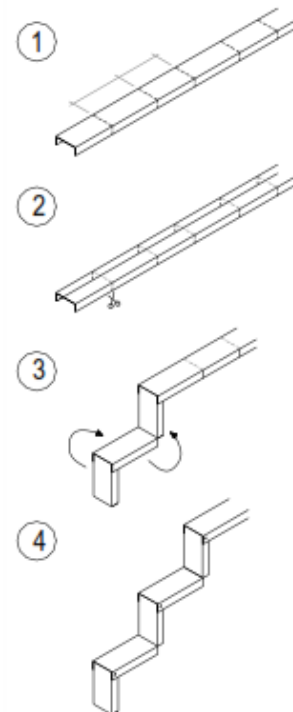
, Escalera con viga inclinada. (Fuente disponible en: SFA-alacero.)
